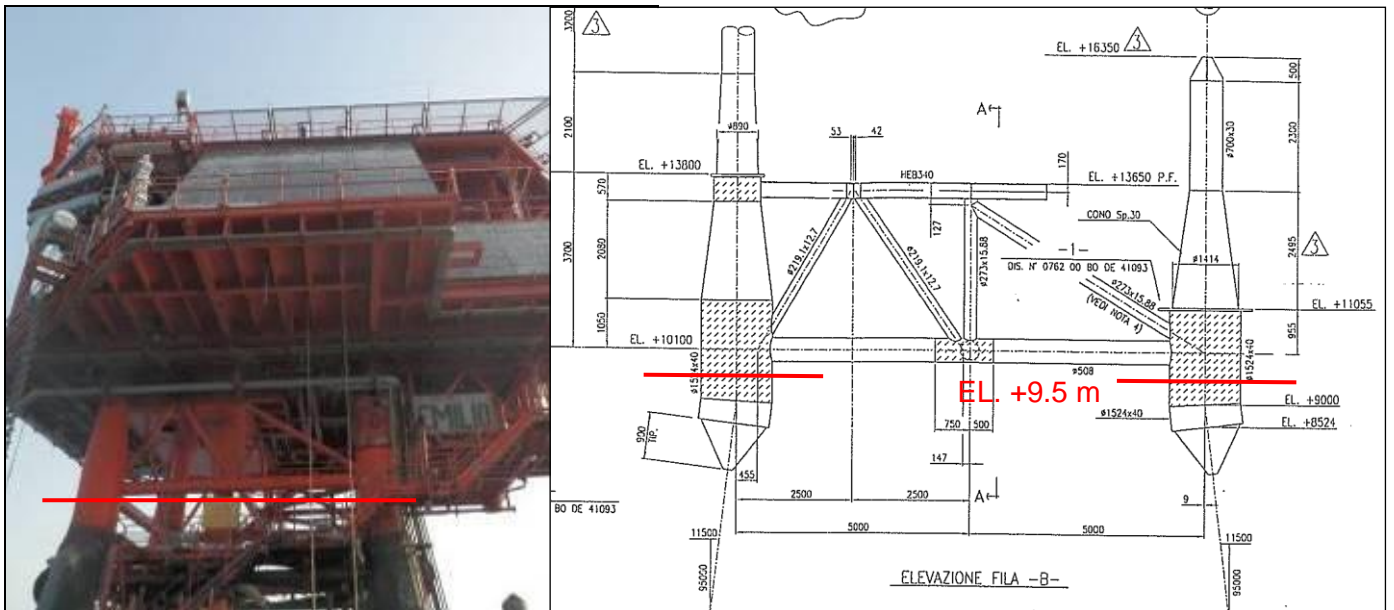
Sezione Taglio Deck e Modulo Testa Pozzo
